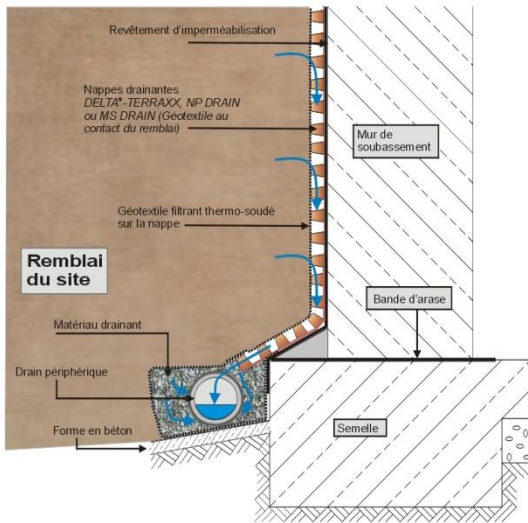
nappe à excroissances drainante – pied de construction imperméabilisation
